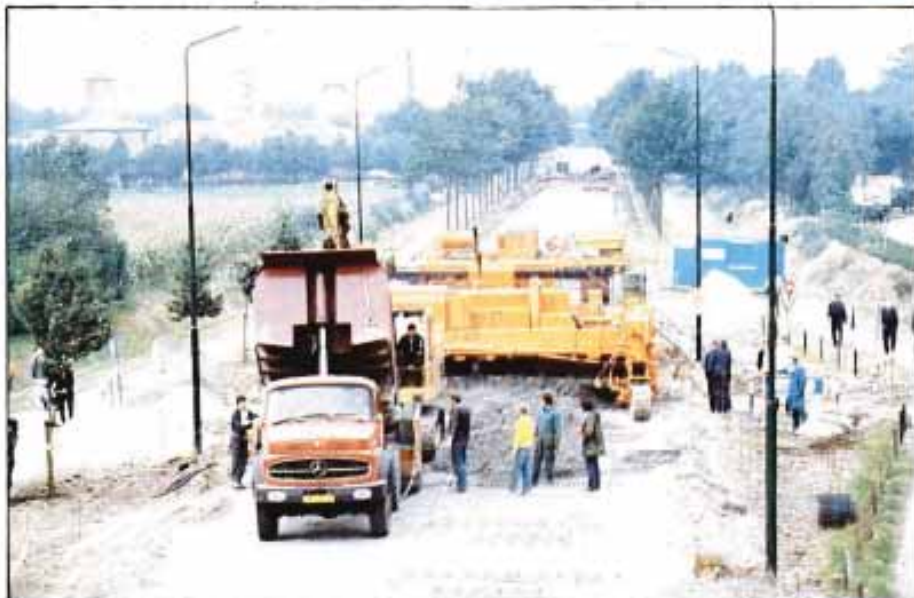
Refuerzo con hormigón de un pavimento de hormigón (Holanda)
